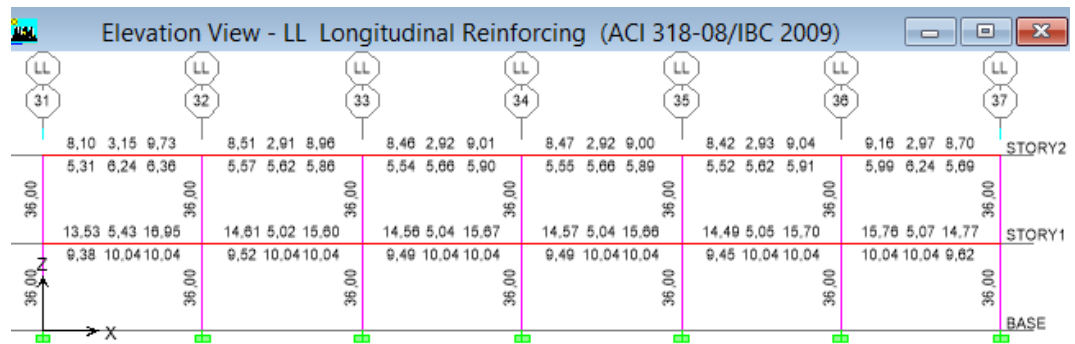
Acero en Vigas y Columnas en el Pórtico LL – C. Quirúrgico- (CEC2002)
